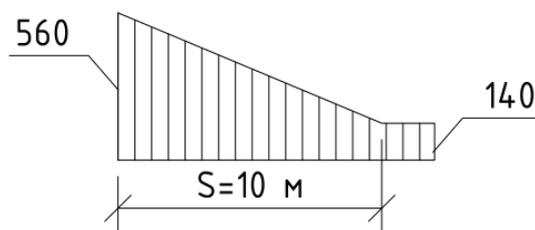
Схема распределения веса снегового покрова в месте перепада профиля кровли
